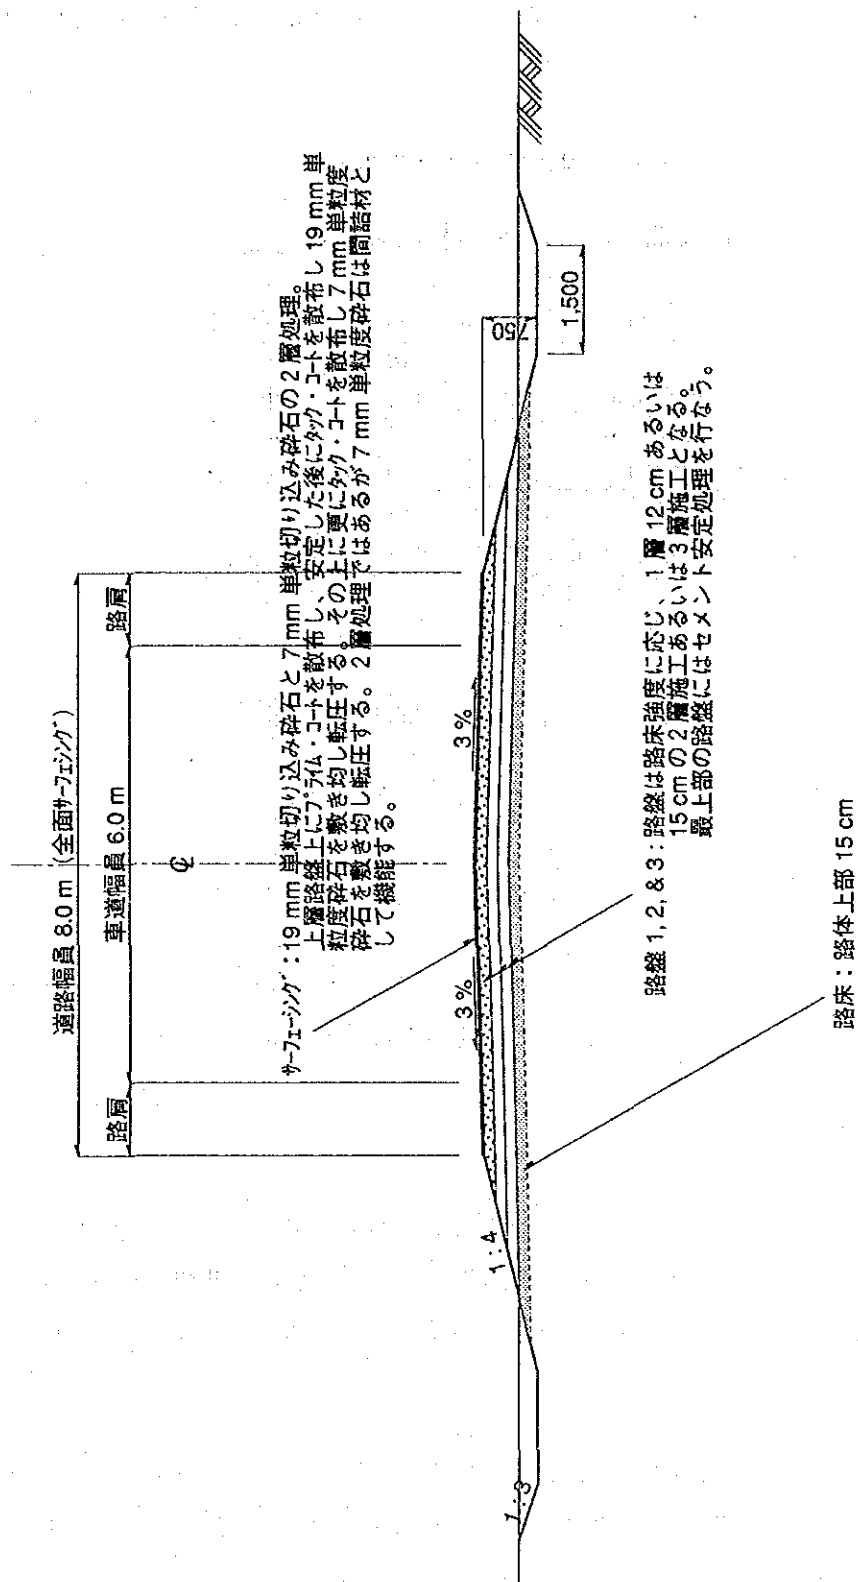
整備路線標準断面図 (橋梁取付け道路含む)
